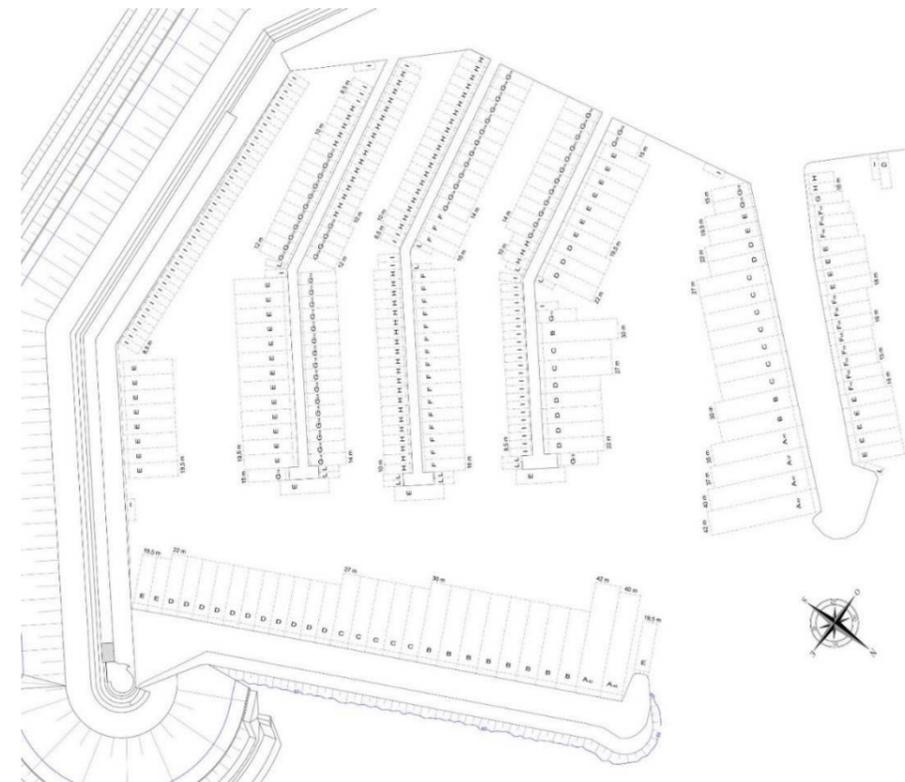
Ricostruzione dell'assetto tipico del layout portuale ante-mareggiata
